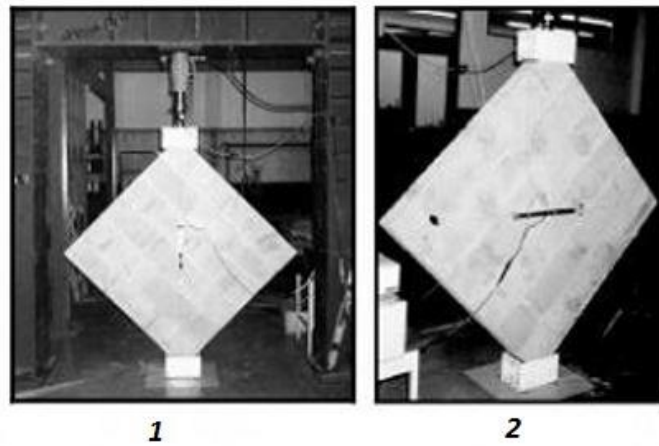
Configuration du test sur les murs [ASTM E 519-02, 2012] ; (1) Test suivant l'ASTM E 519 ; (2) Plan de rupture potentiel suivant le lit de joint
